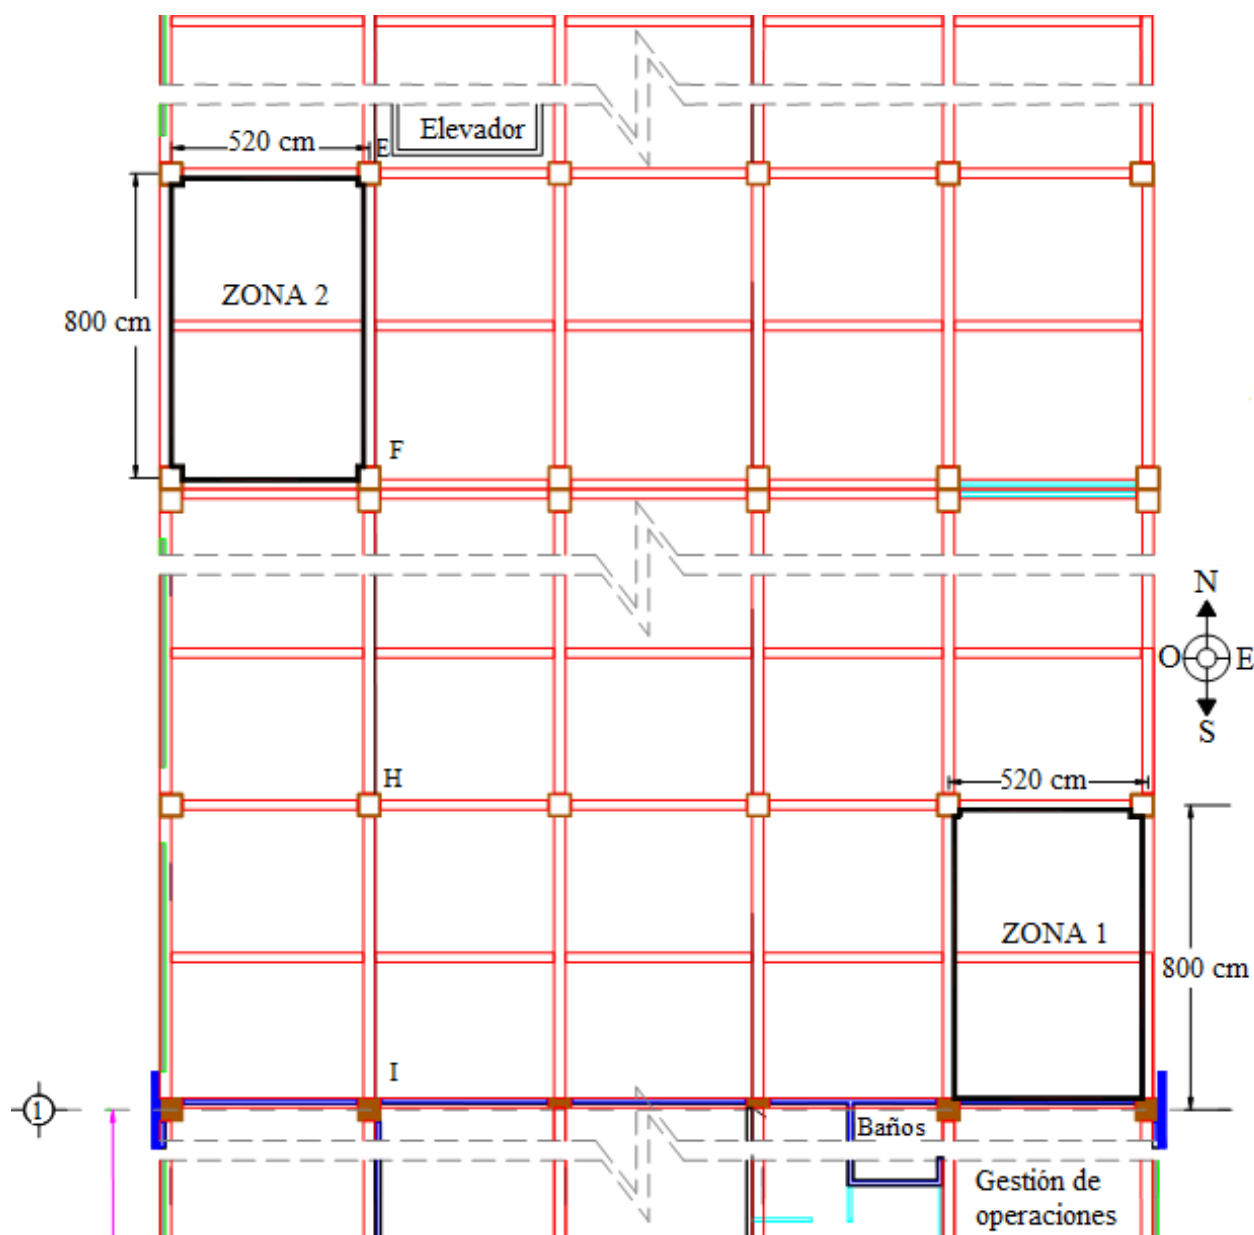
Esquema de las Zonas inspeccionadas en las losas de las Zonas 1 y 2
